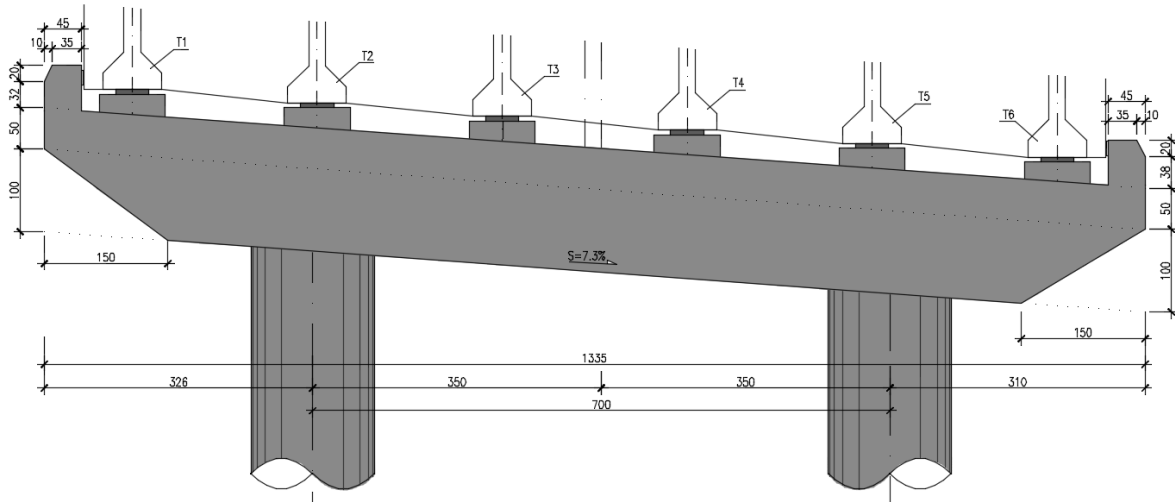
Alçado da viga de encabeçamento (Travessa).
